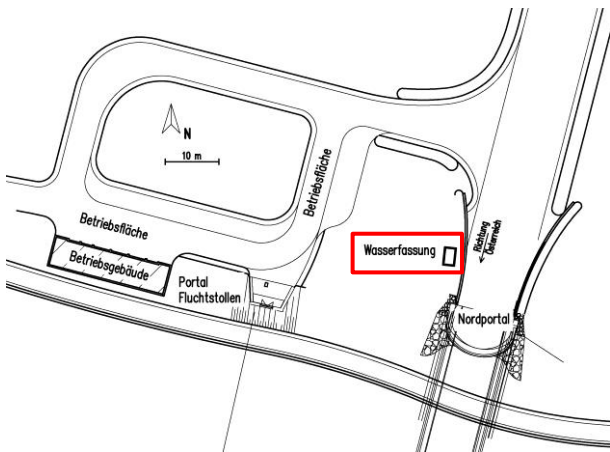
Wasserfassung Füssen; Skizze Lageplan
